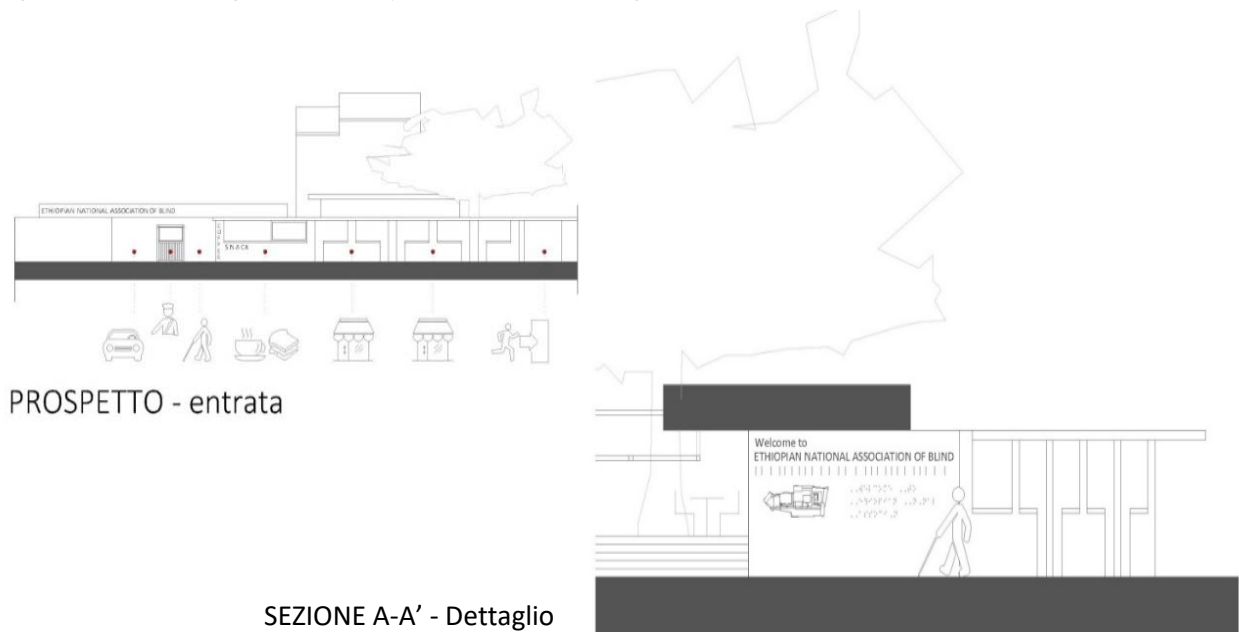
, b, c, ENAB: Progetto definitivo, planimetria e sezione longitudinale
